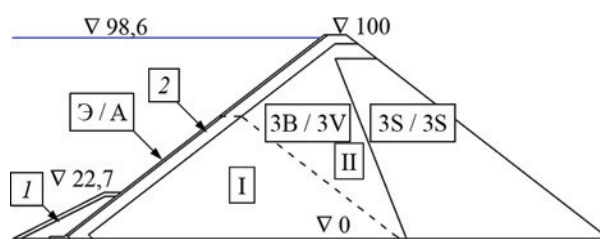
Схема конструкции каменно-набросной плотины с железобетонным экраном: 1 — защитная призма; 2 — подэкрановая зона; 3 — упорная призма; Э — железобетонный экран; I, II — очереди плотины
